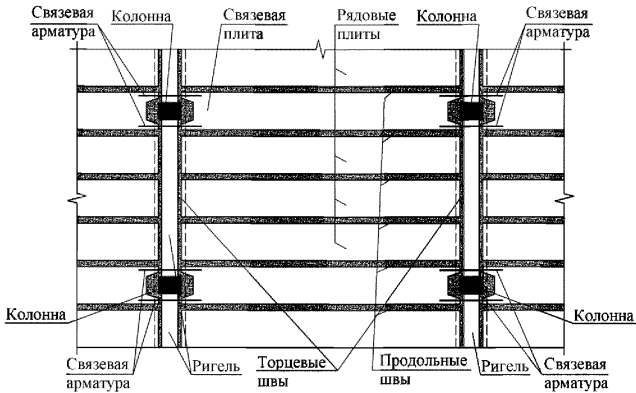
Фрагмент сборного перекрытия из многопустотных плит
